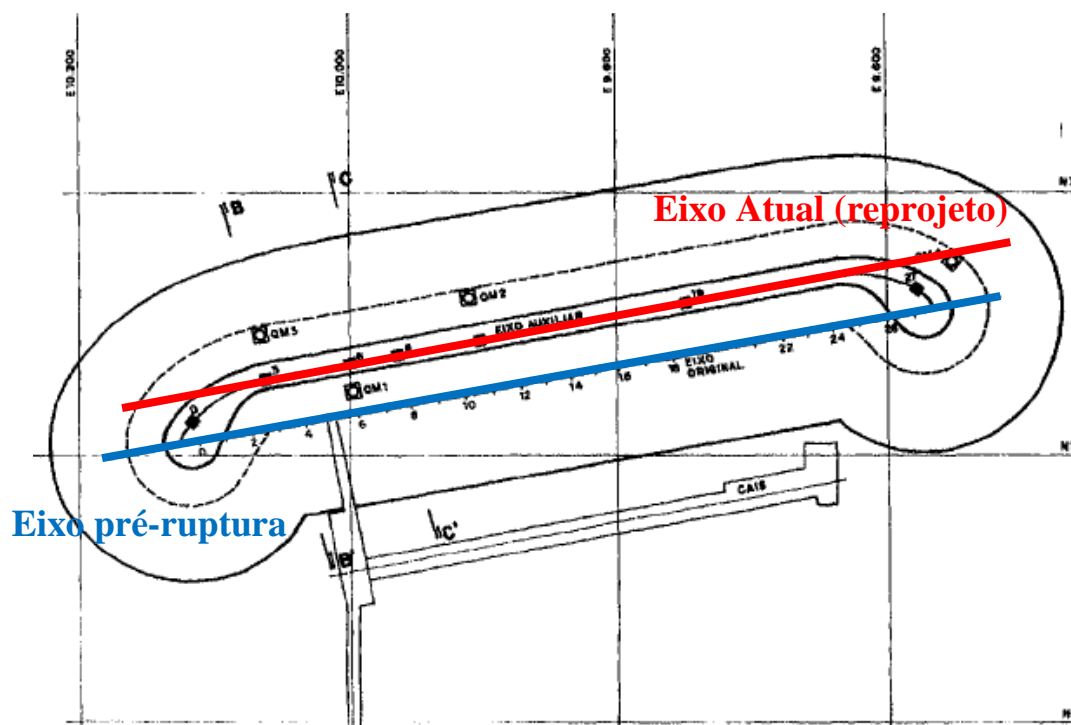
Planta esquemática do reprojeto do quebra-mar
